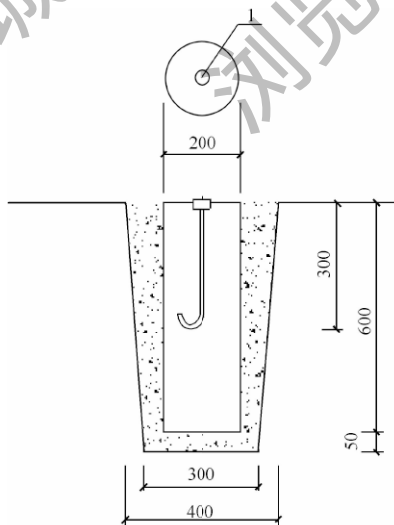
一二级控制点预制混凝土标石造埋规格 (mm)
